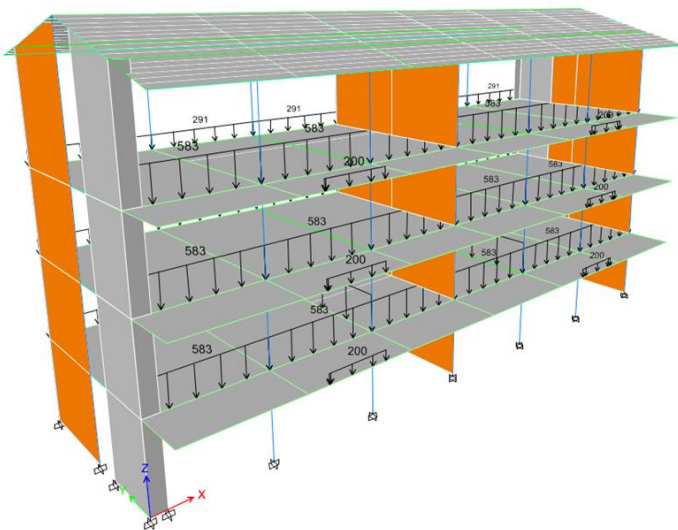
Cargas Distribuidas en Vigas en el Módulo N° 1
